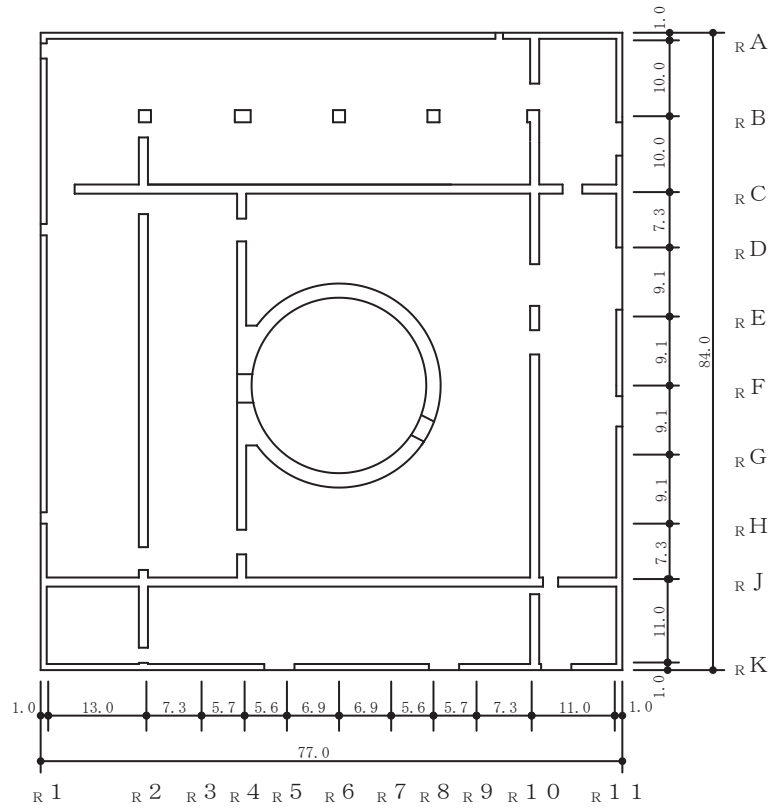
(2) 原子炉建屋の概略平面図 (0.P. -0.8m)
